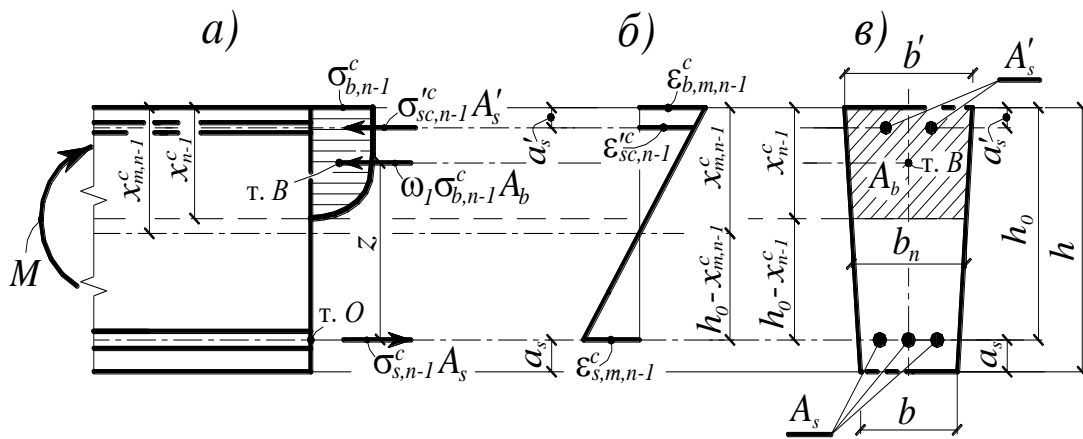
Напряженно-деформированное состояние железобетонной изгибаемой конструкции в стадии II: а – схема усилий в поперечном сечении; б – гипотеза плоских сечений для средних деформаций в блоке между трещинами; в – поперечное сечение
